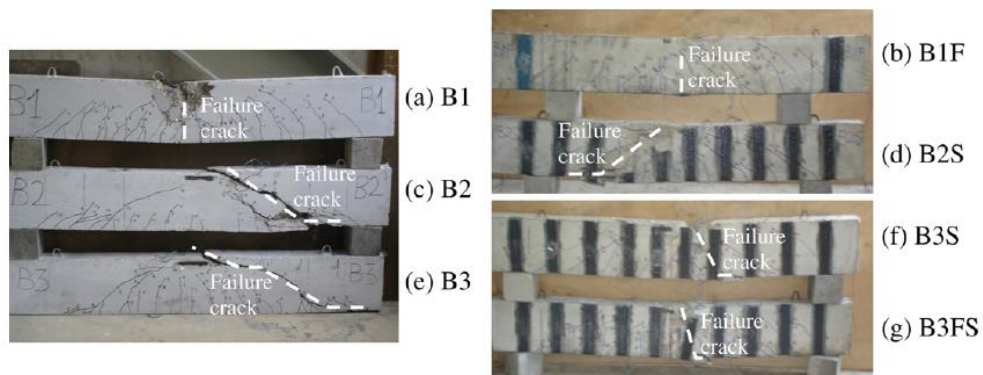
(repetida) – Patrones de fisuras de las vigas probadas a la falla.
